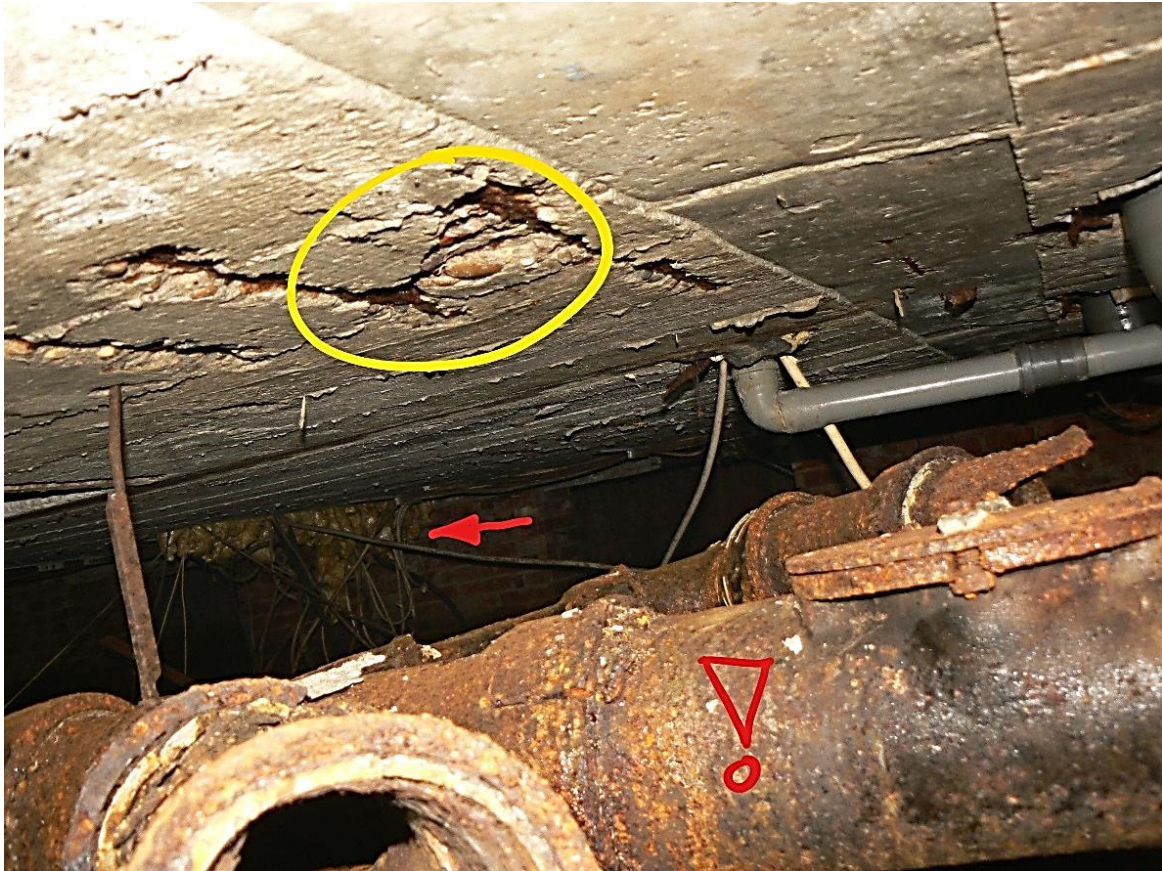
Foto Kriechkeller, Datum: 04.03.2021
